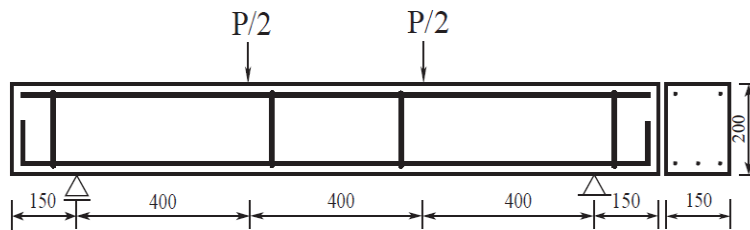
供試体の寸法および配筋の状況 (No. 1, No. 2)
